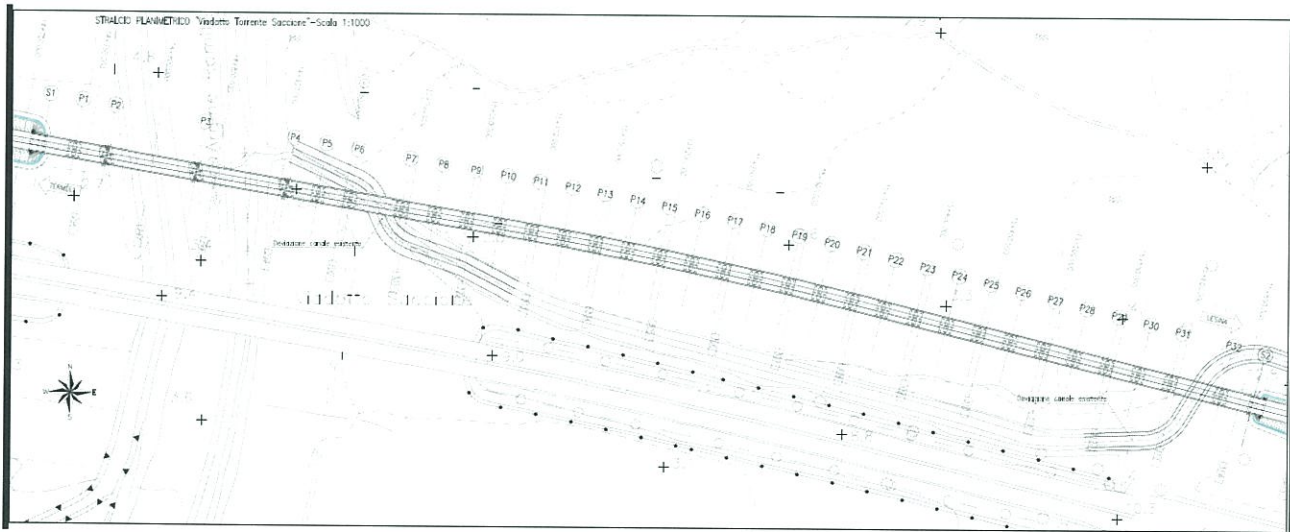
Viadotto sul torrente Saccione: stralcio planimetrico
